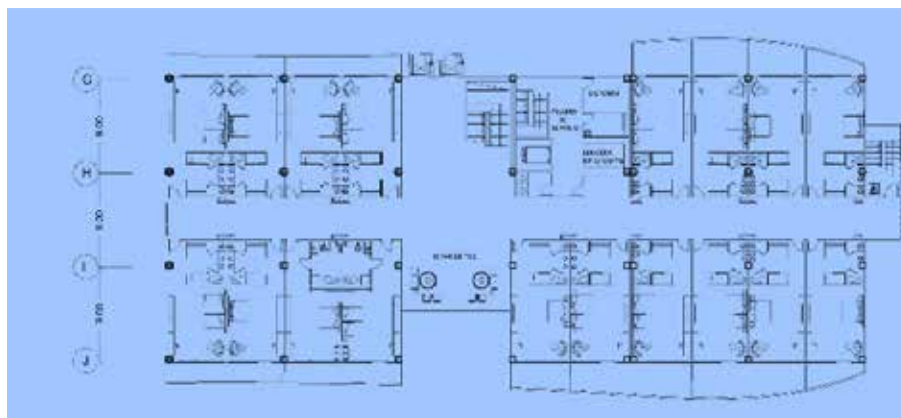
Planta Tipo Habitaciones Autora: Cáceres (2017).
